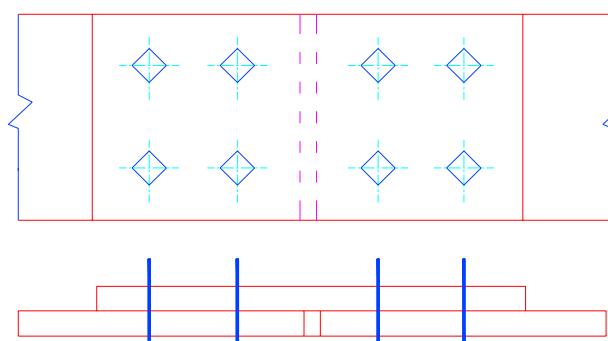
Bố trí đinh tán trong các loại thép hình
